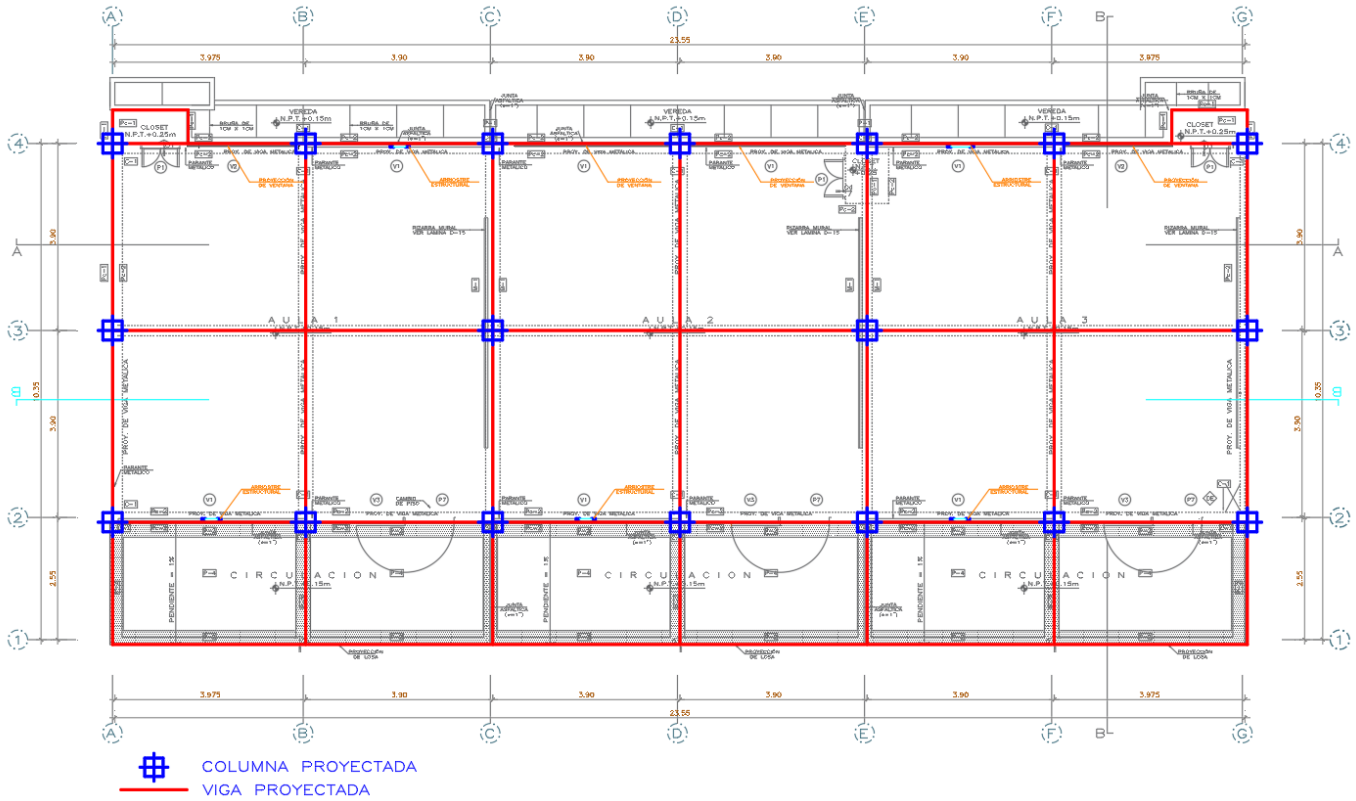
Estructuración — Planta: Distribución de vigas y columnas
